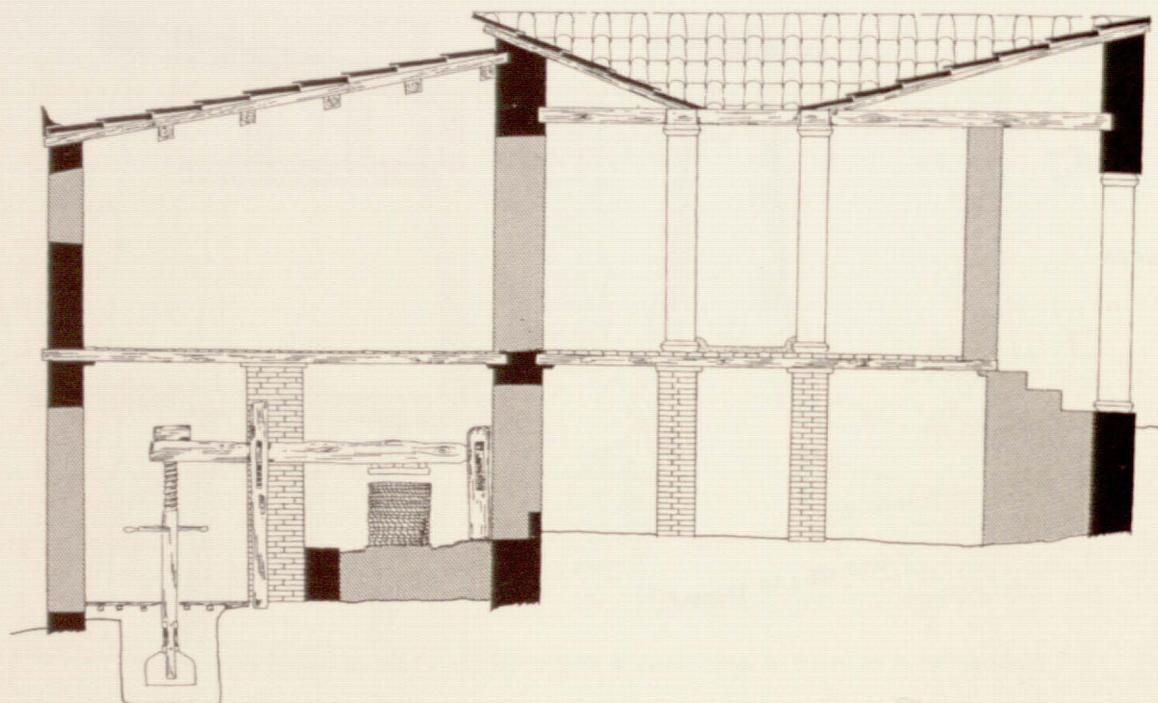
Casa 2, corte transversal este-oeste. El atrio del piso superior se sitúa sobre la habitación 2 de la planta baja. Prensa de aceite en la habitación 3.
